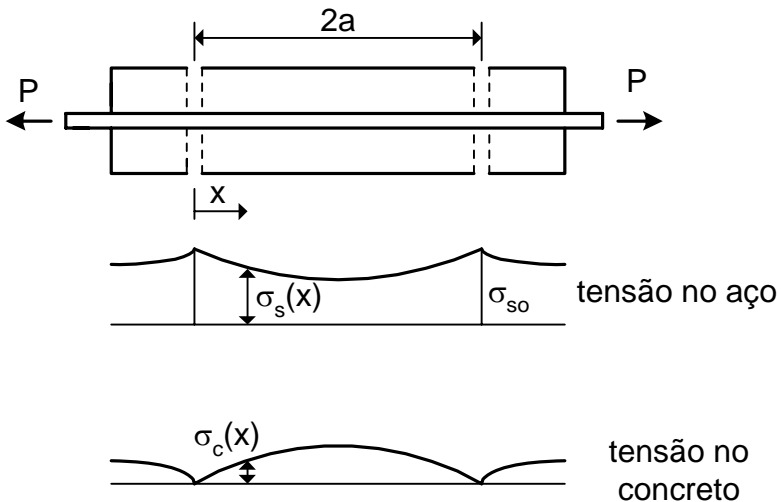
Elemento fissurado sob tração simples
